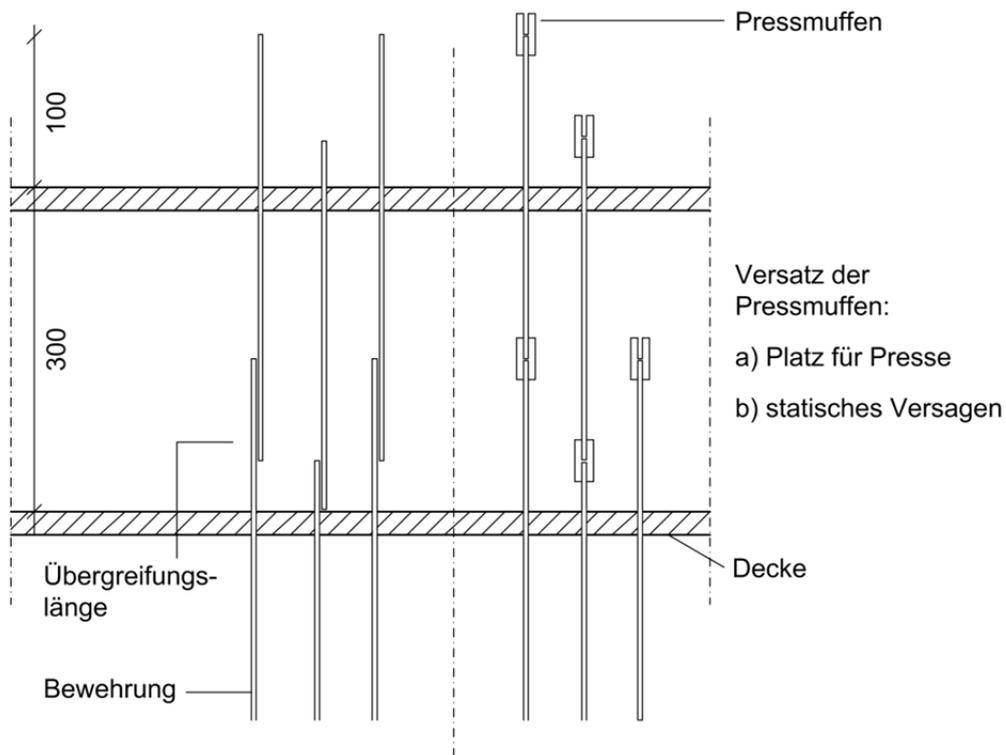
Wandpressmuffenstösse der Bewehrung
